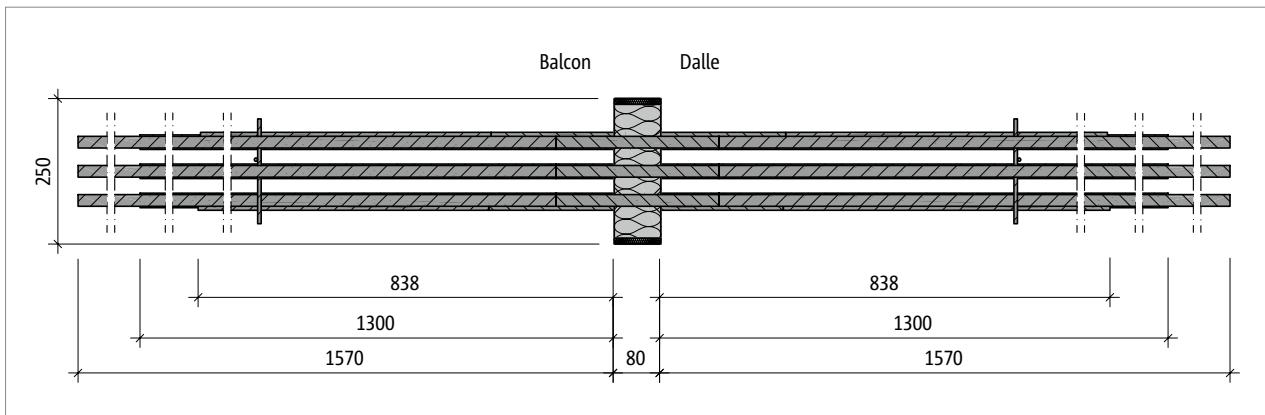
Schöck Isokorb® T Type B-M5-V2 : Plan de base du produit
